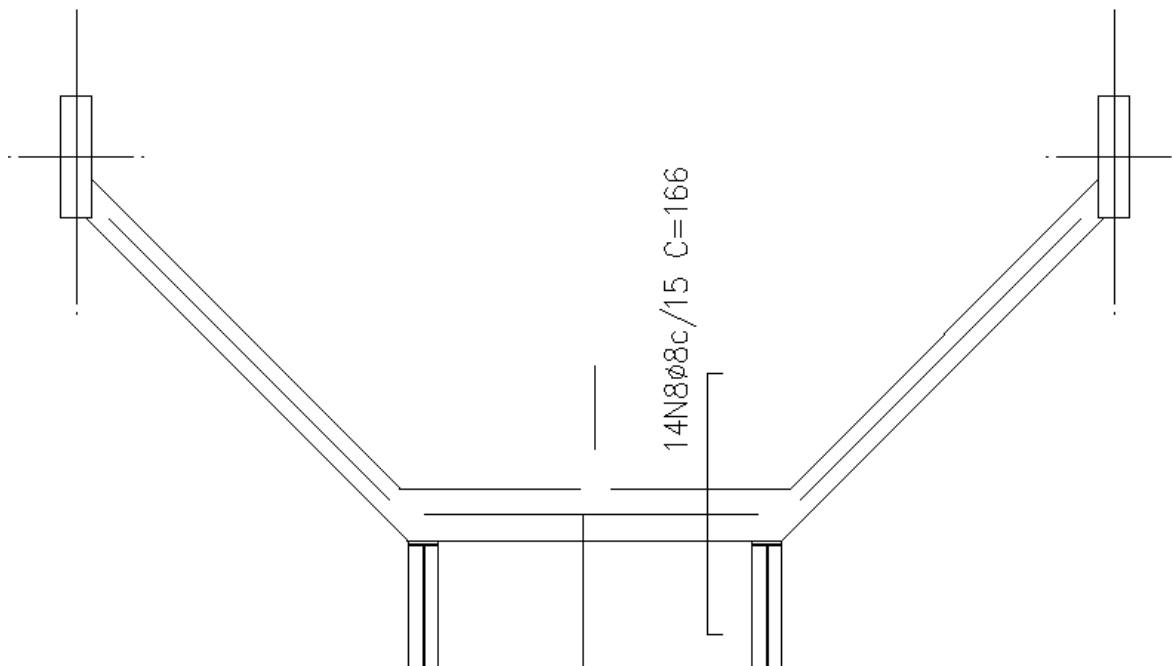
Detalhe da armadura negativa na região da fissura
